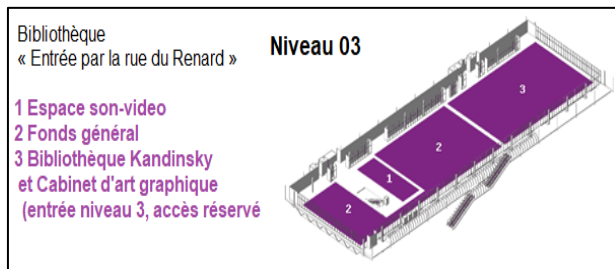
Plan Niveau 3 Source : Pinterest.com/
